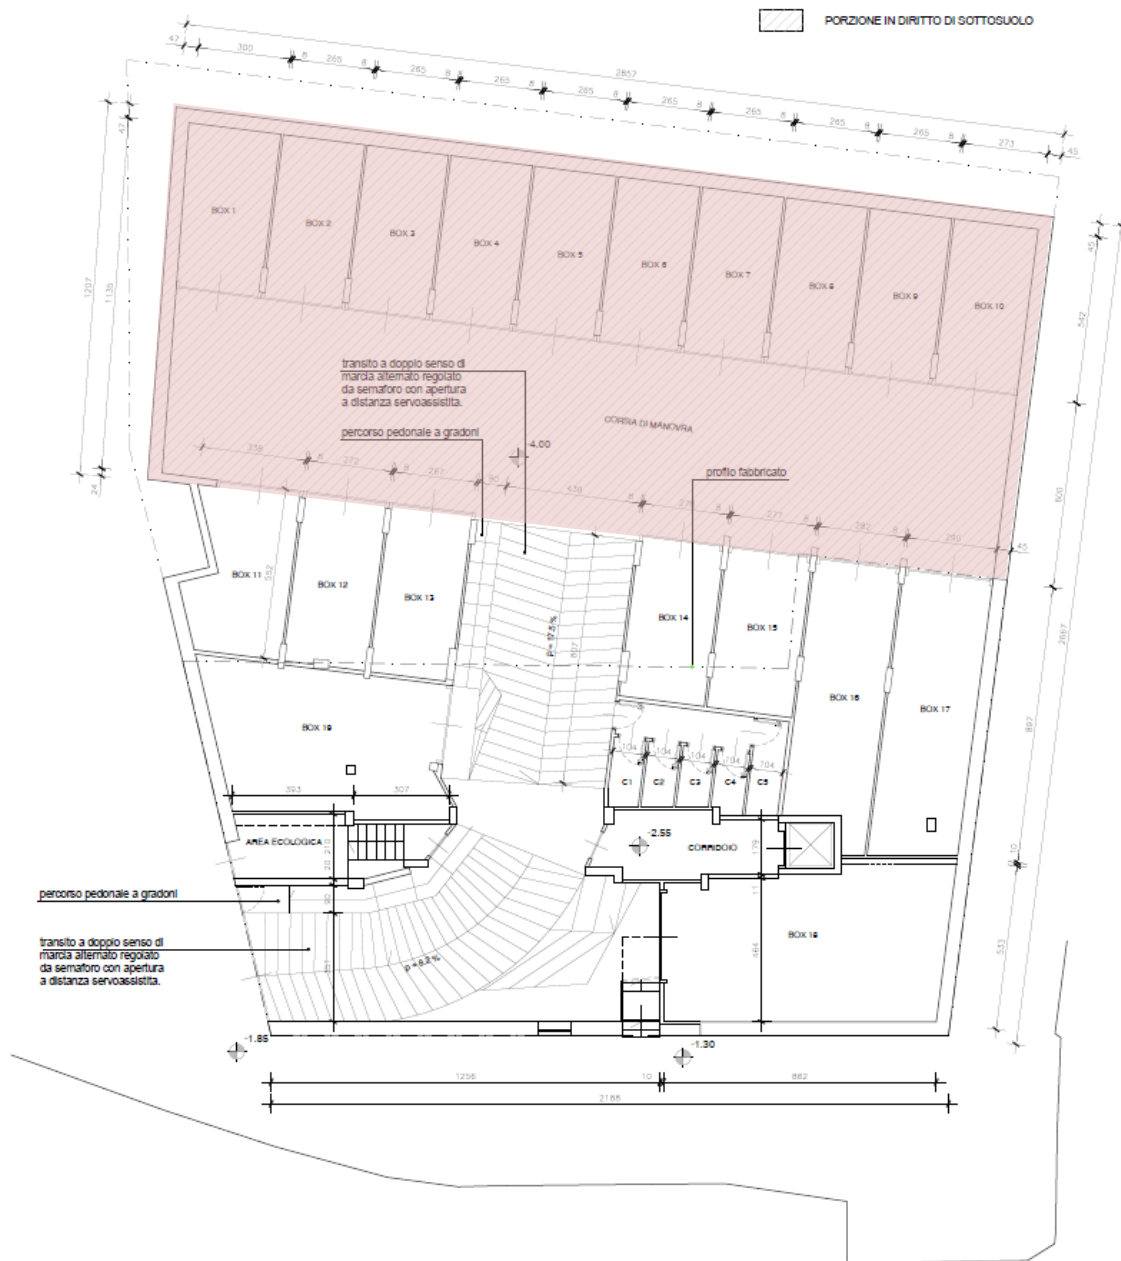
ESTRATTO PIANTA PIANO INTERRATO SCIA N. 5729 DEL 21/07/2017
